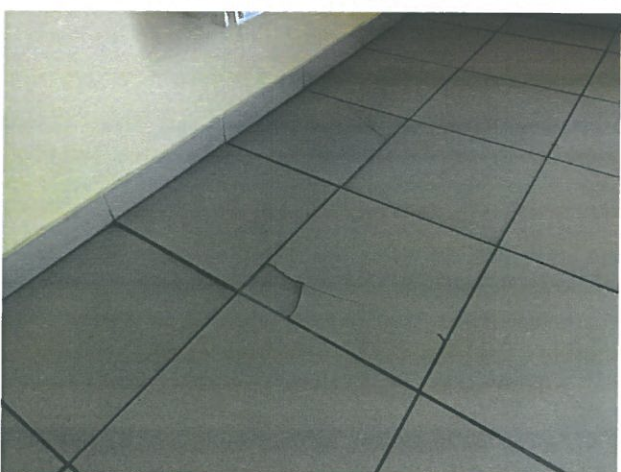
,24 – Lokalnie zapadnięta posadzka na wysokości około 14 mm.
